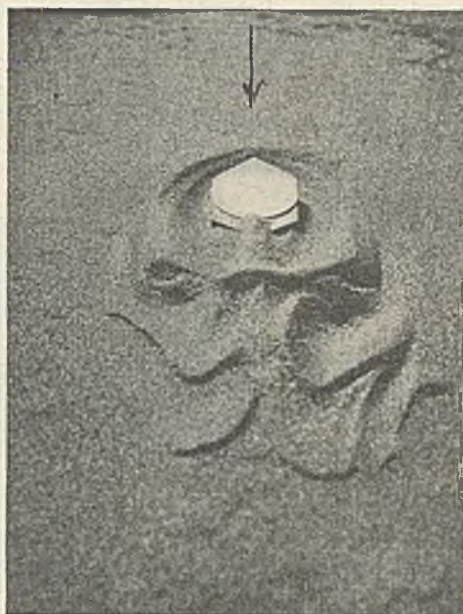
Geradlinig begrenzter Pfeilerunterbau.
